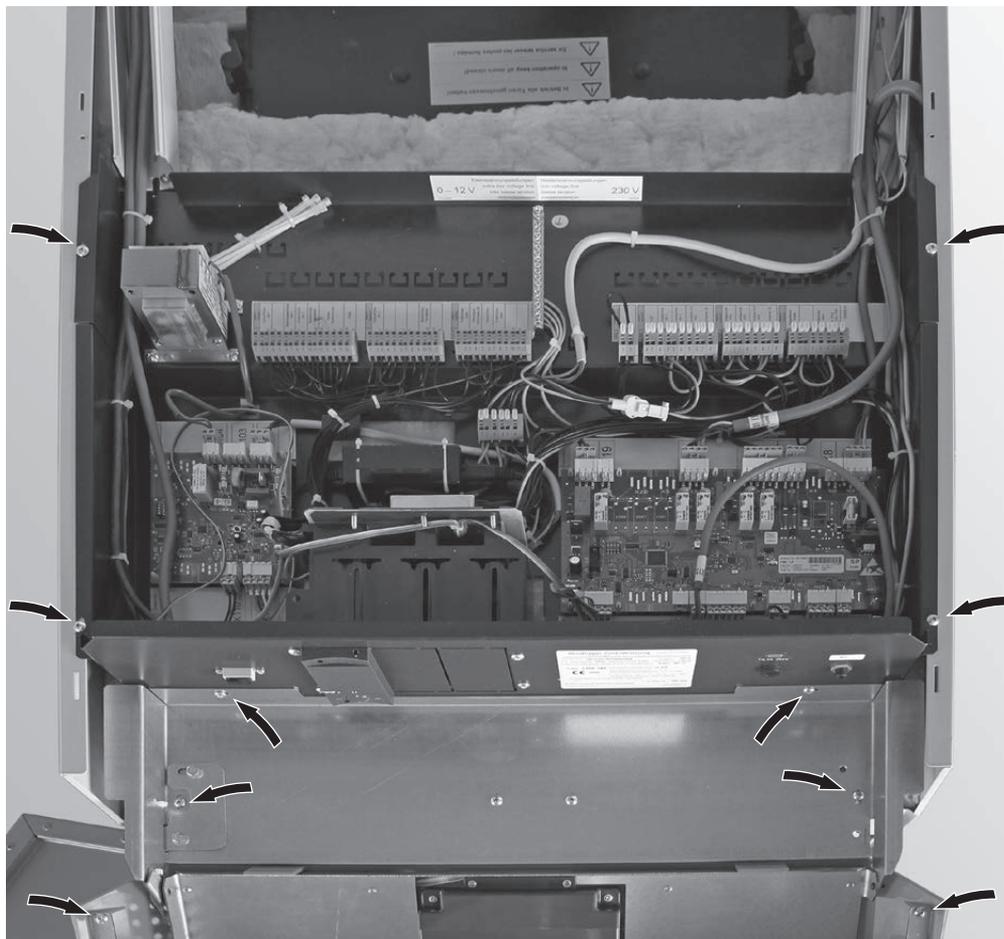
Aggiustare il rivestimento, serrare tutte le viti
